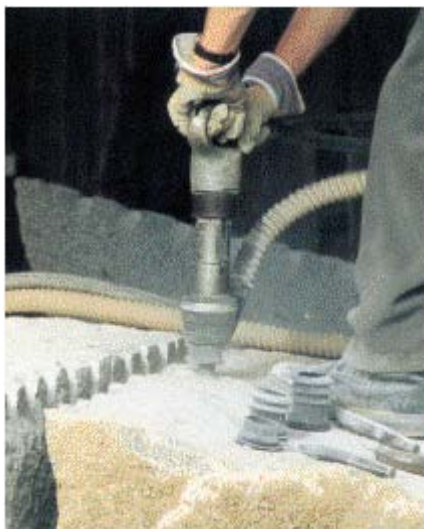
Das Werkzeug umschließende Gummitülle zur Stauberfassung
